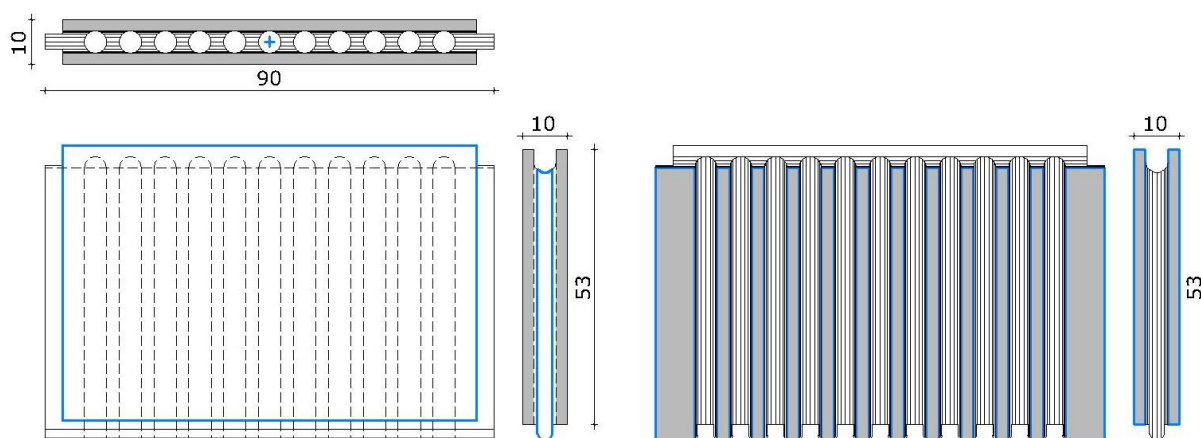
Planta baixa e cortes da tipologia de placa vazada.
